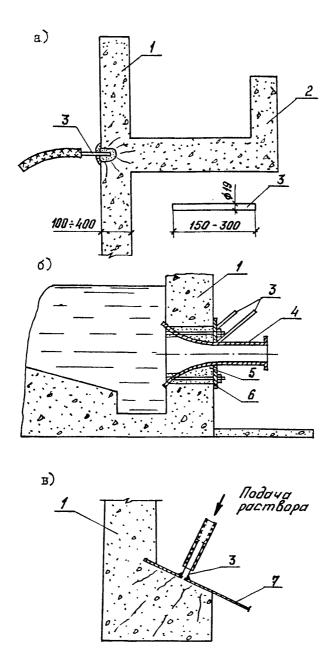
Ремонт железобетонных емкостей при протечках
